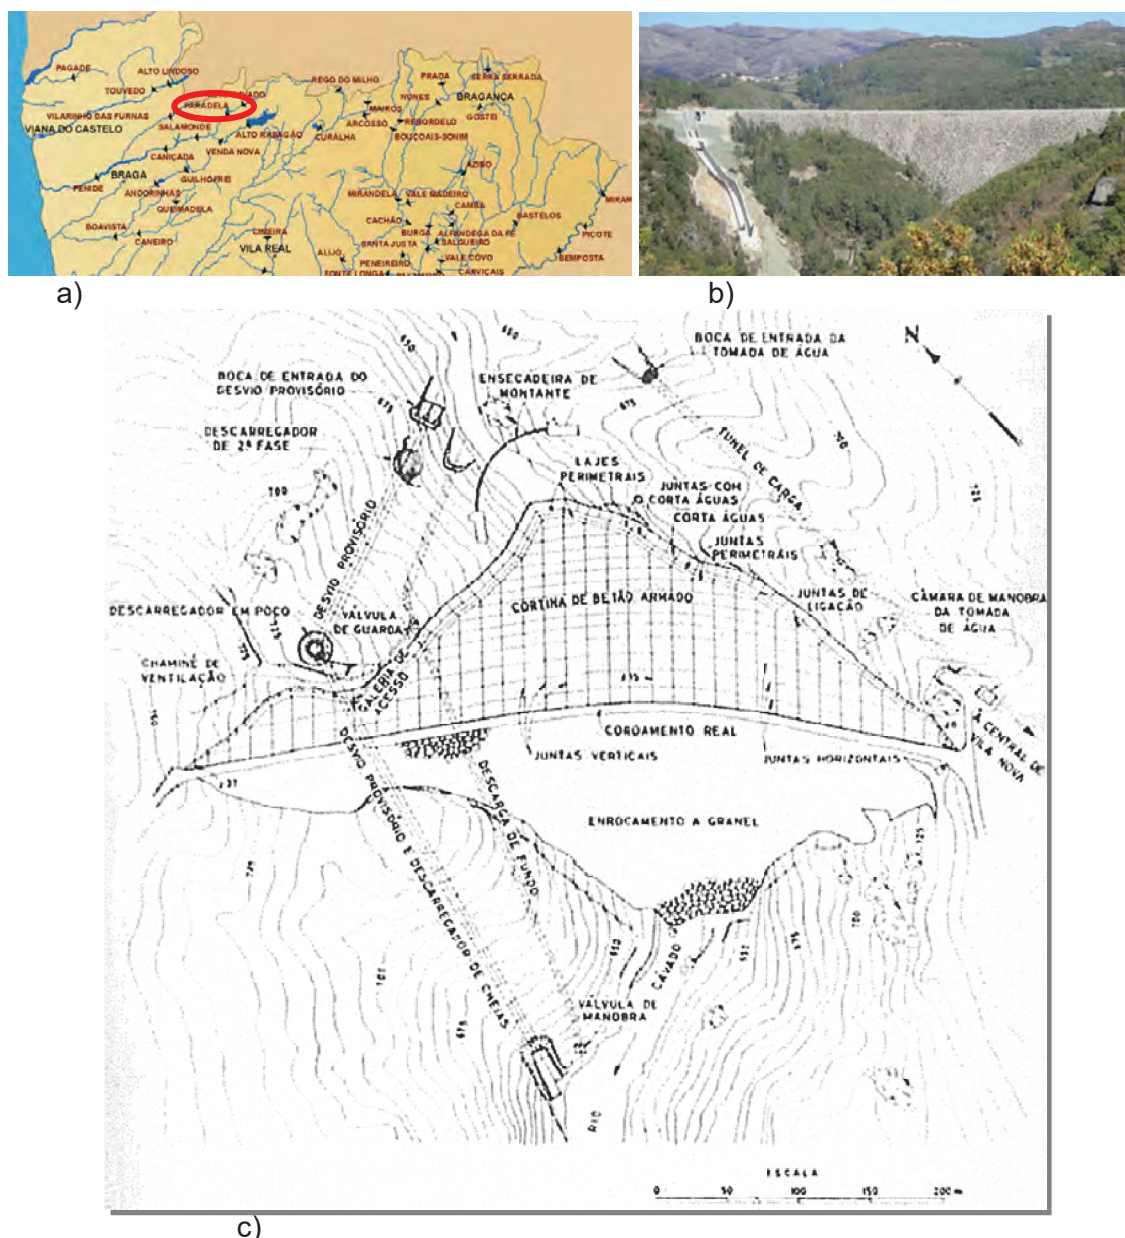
Barragem de Paradelas (a- Localização; b- vista geral de jusante; c- planta geral)
